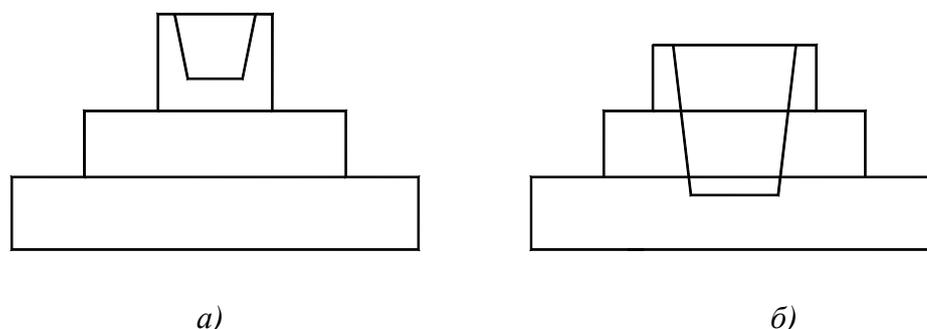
Фундаменты под колонну: а – с подколонником;
